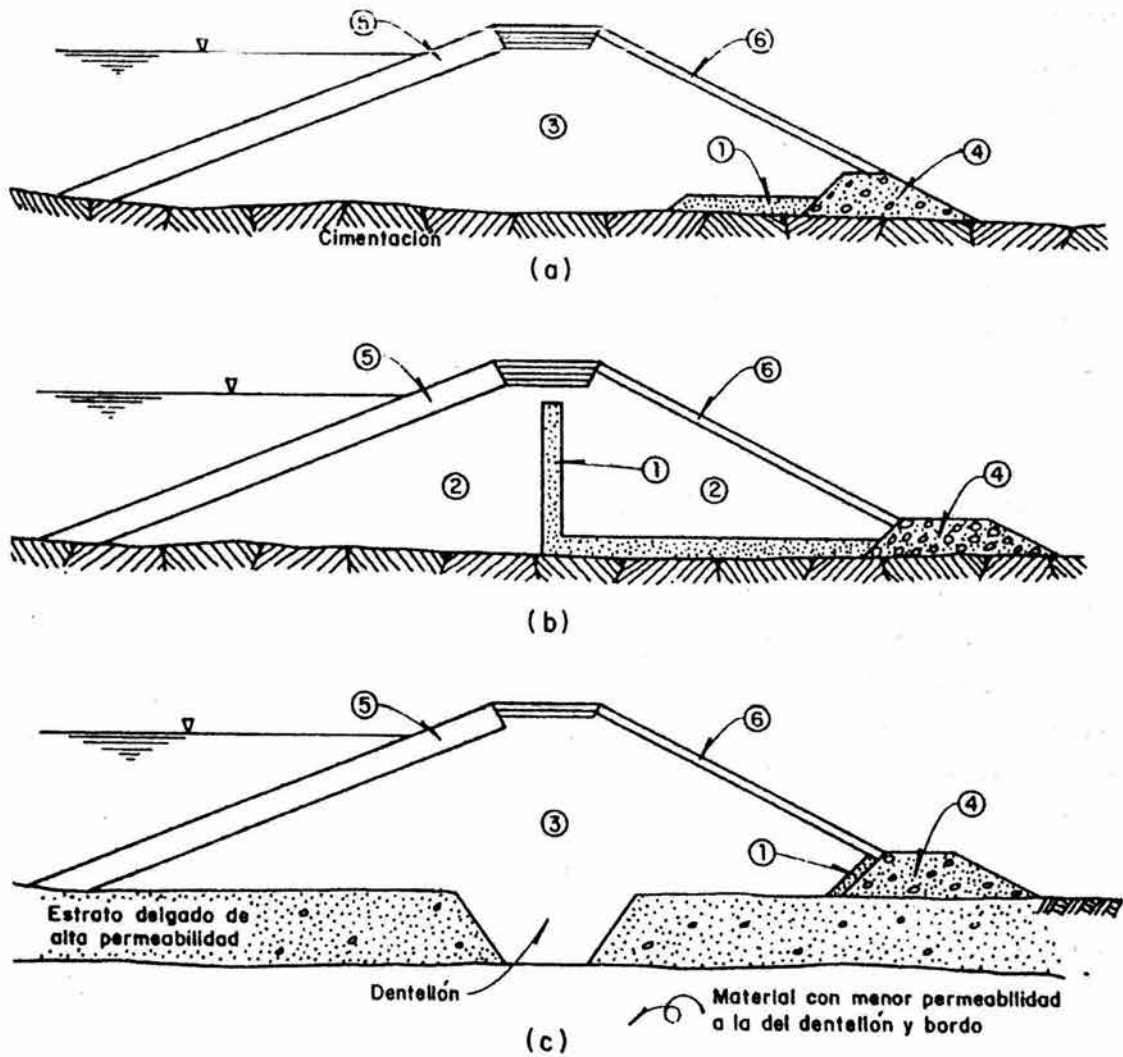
Secciones transversales típicas de bordos de protección o encauzamiento (Mendoza, 1998)
